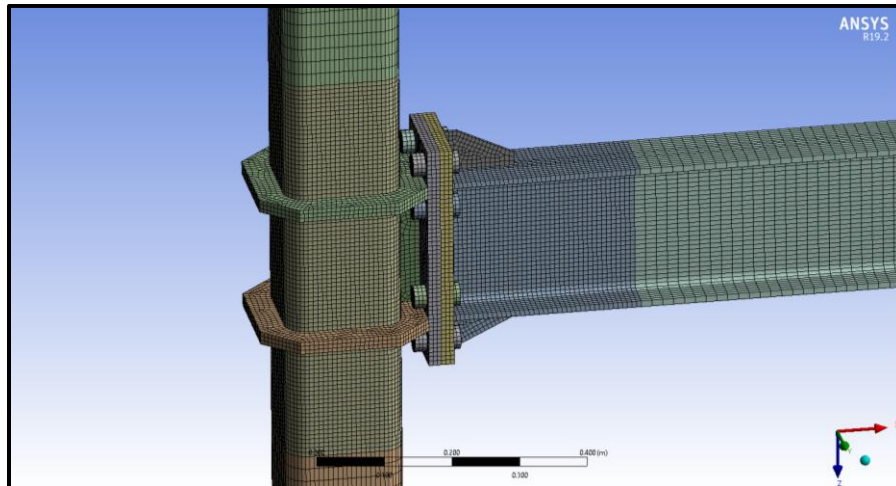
Conexión Tipo II con diafragmas externos y columnas cuadradas.
